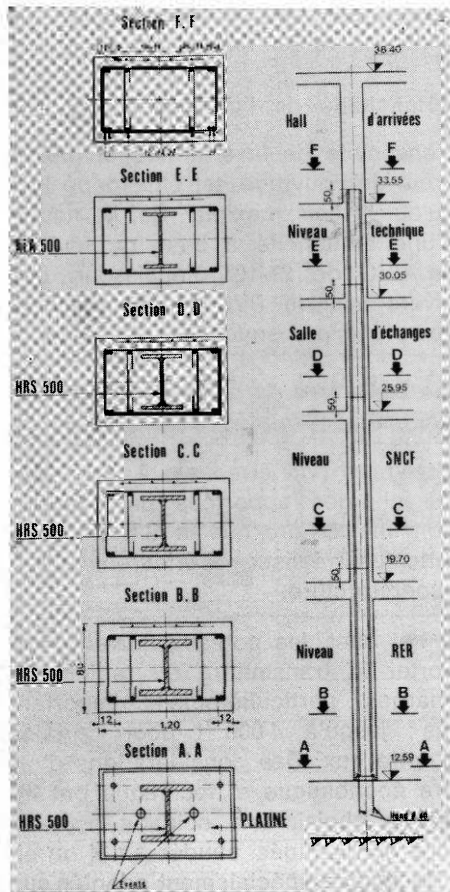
Ouvrage principal. Vue d'un poteau et de son profilé métallique.
